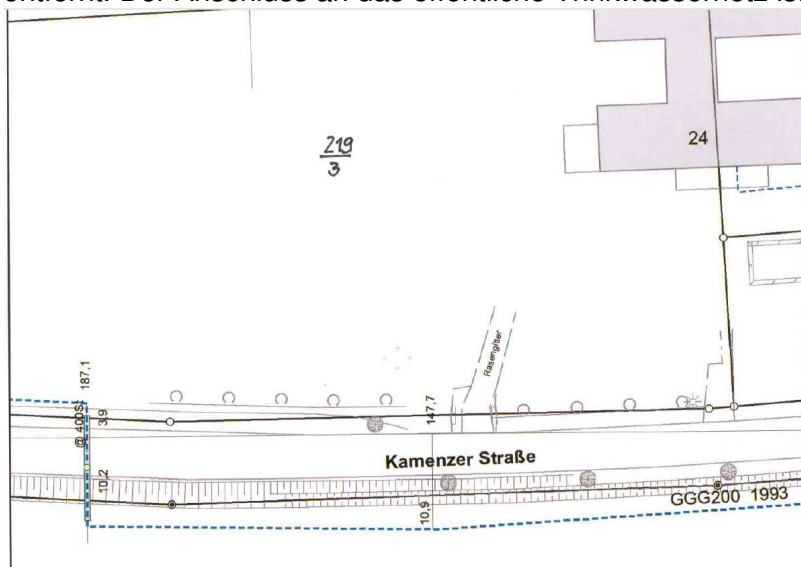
Bestandsplan Trinkwasser ewag Kamenz
